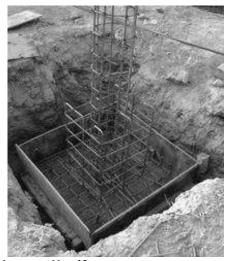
Armado de una zapata aislada, se muestra la parte de columna, el dado y parte del armado de la losa.
